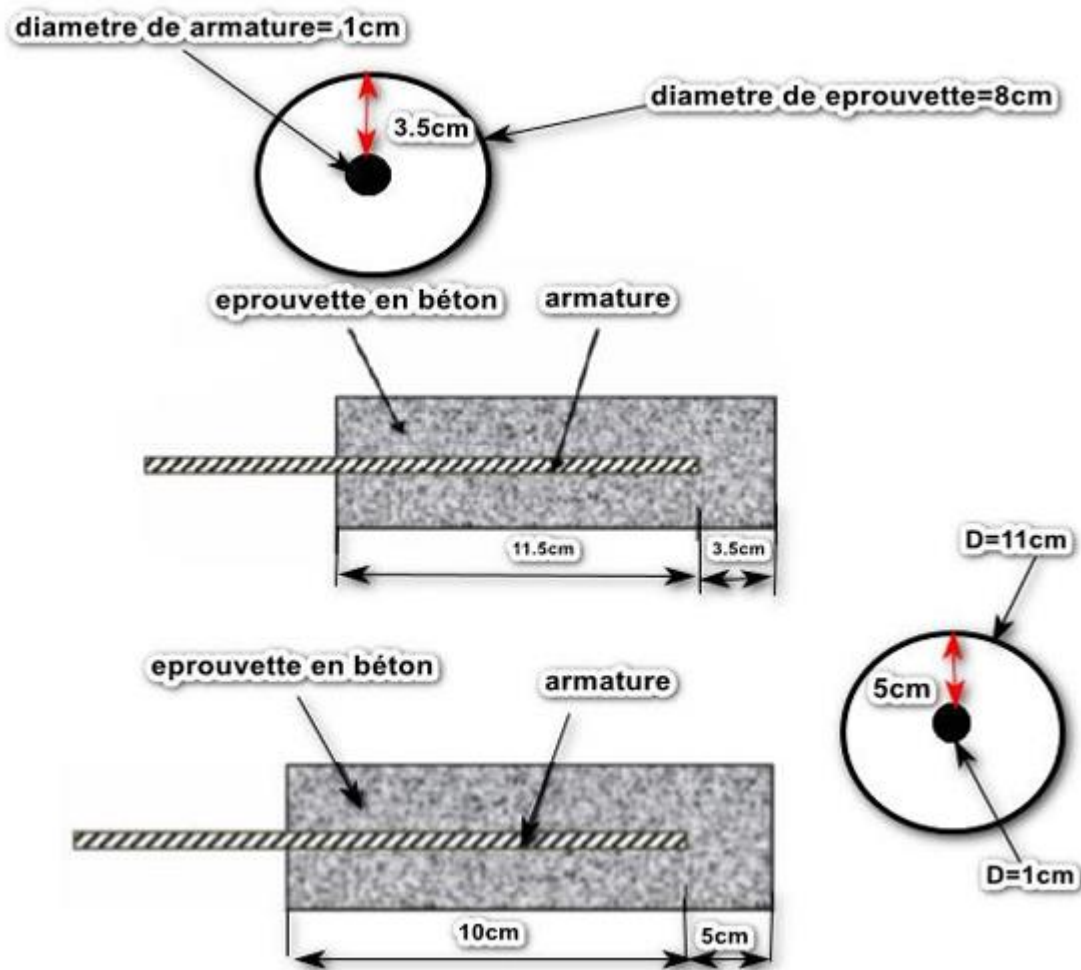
15 SCHEMA D'UNE EPROUVETTE CYLINDRIQUE EN BETON ARME
